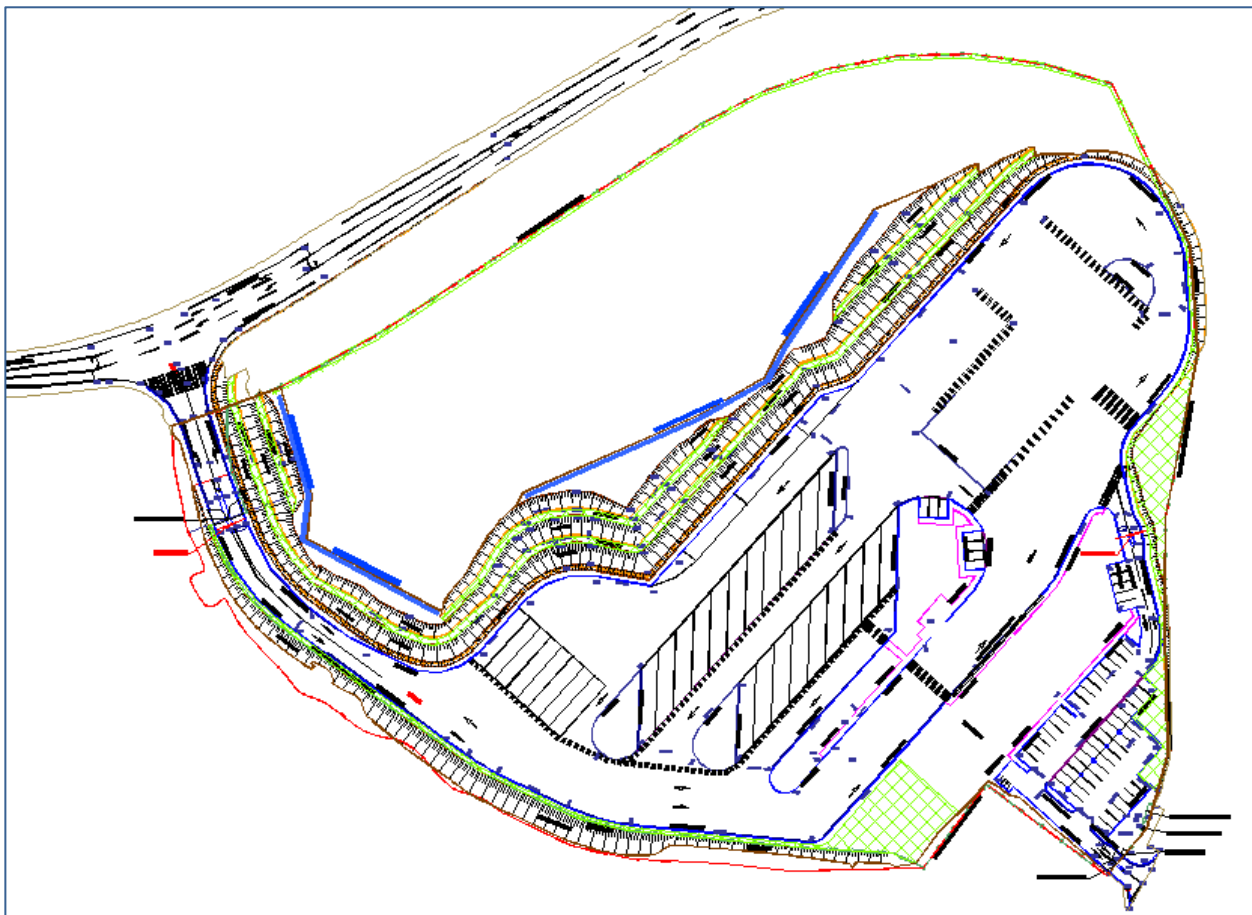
Plan de plantation de forêt sèche (zone en vert)
